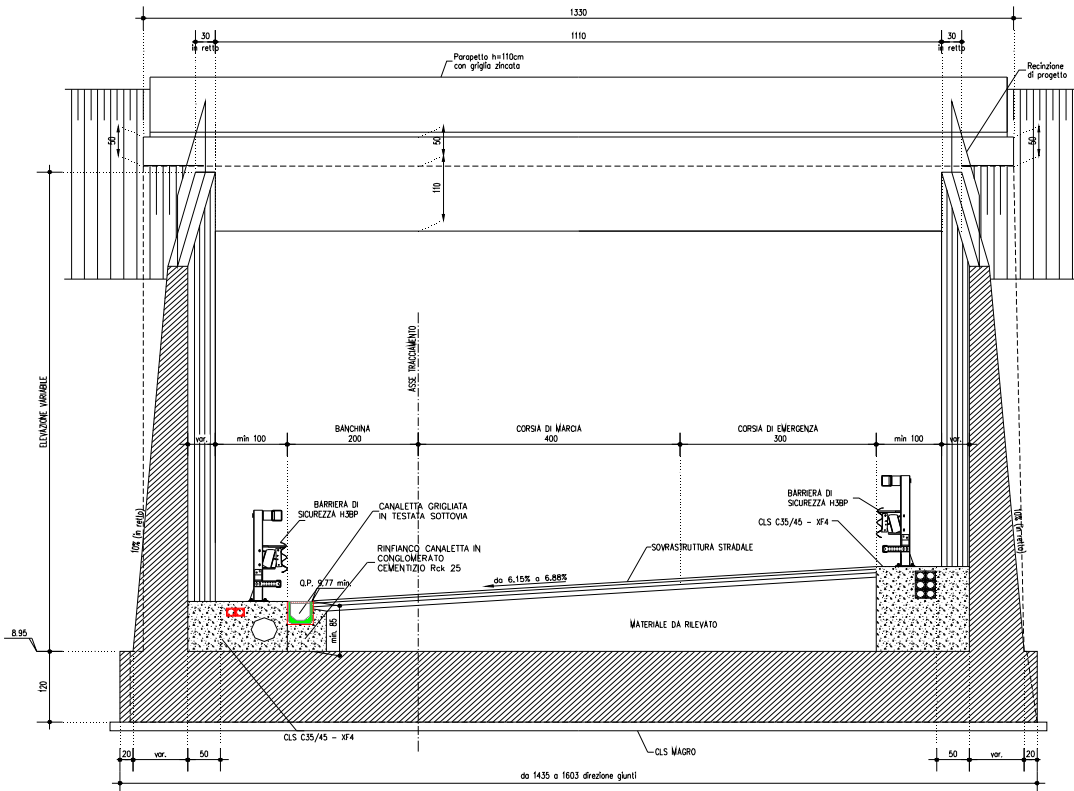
SEZIONE TRASVERSALE MURI
